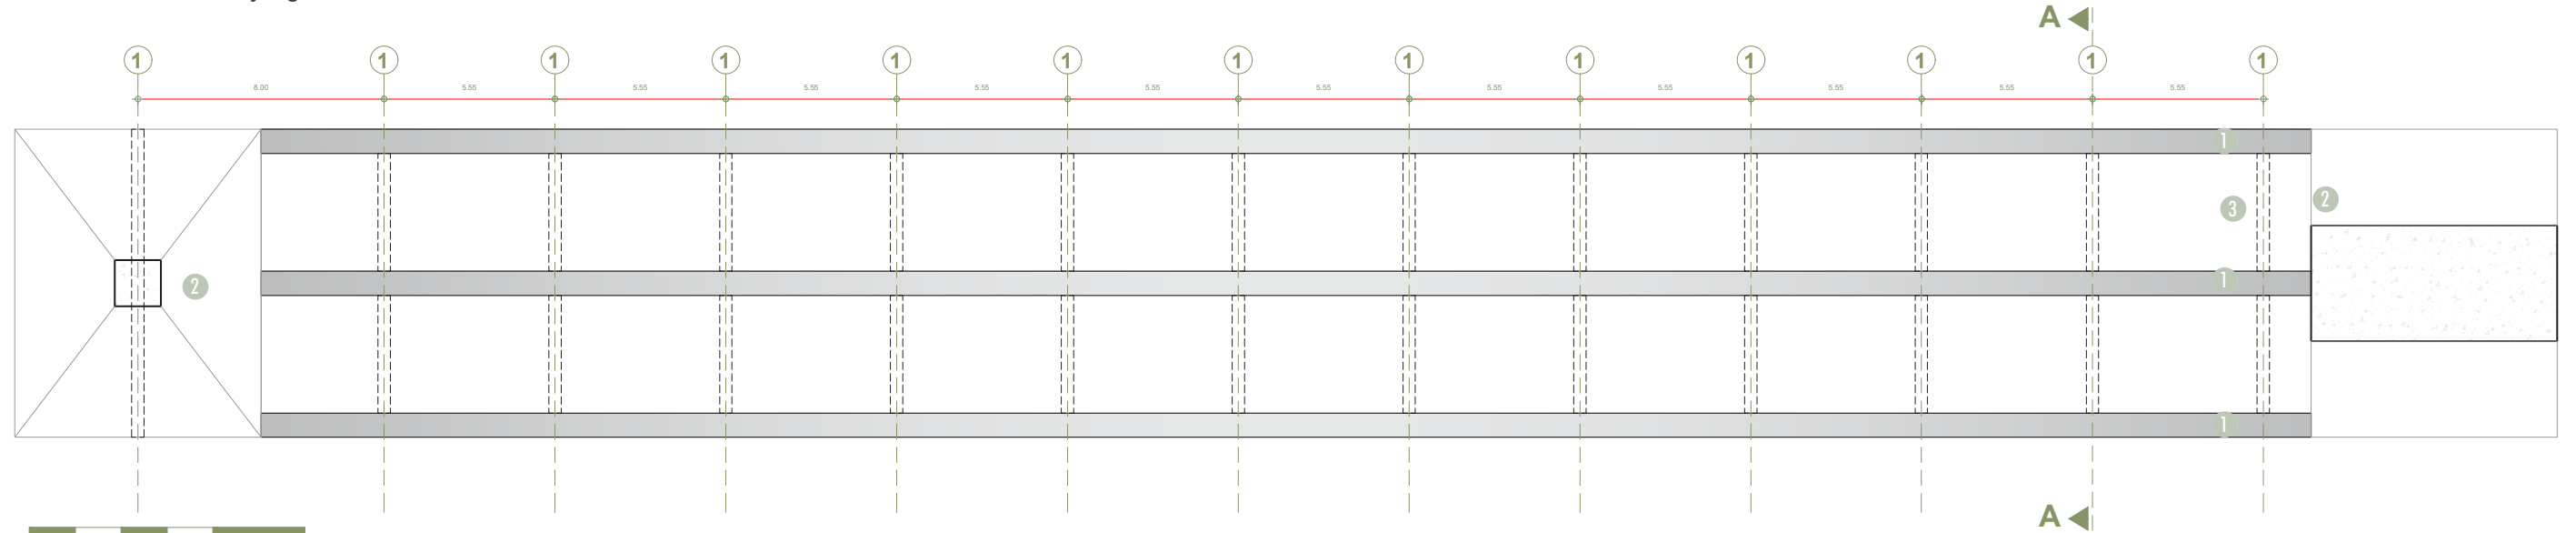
Planta de Cimentación y Configuración de Tableros Estructurales
